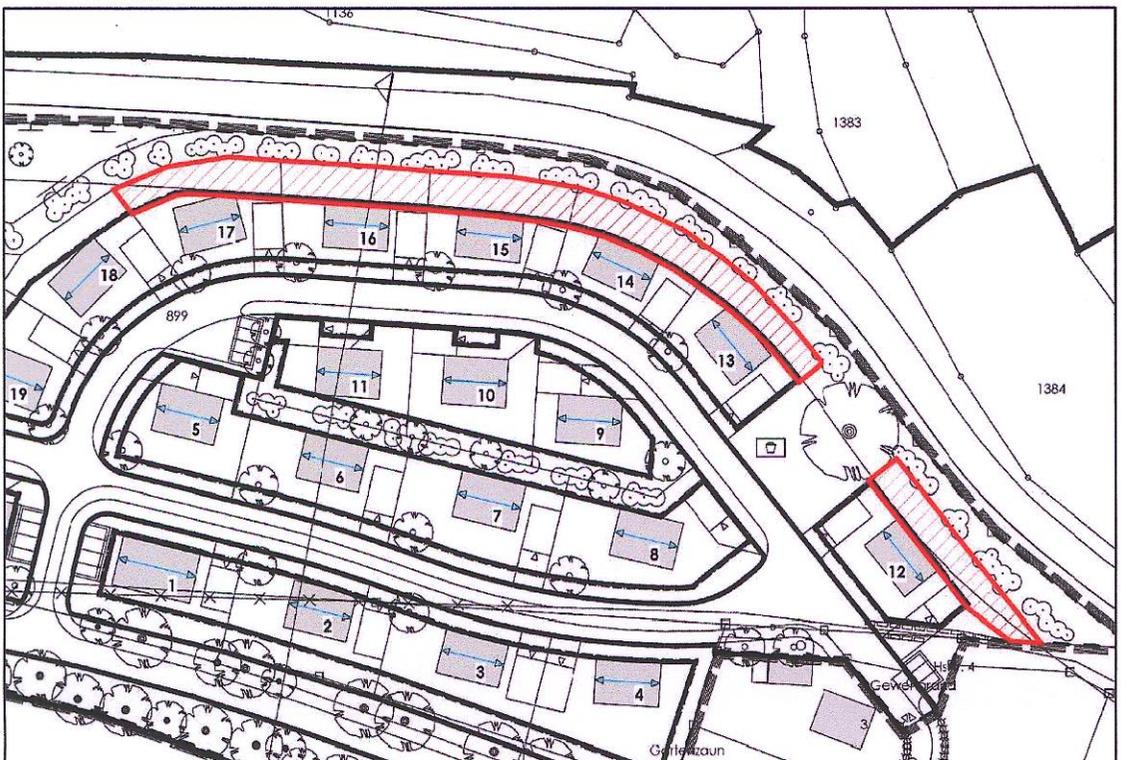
Lageplan mit Kennzeichnung der relevanten Teilflächen der privaten Grundstücksflächen, an denen Schallschutzmaßnahmen erforderlich sind (M 1:1.500).
